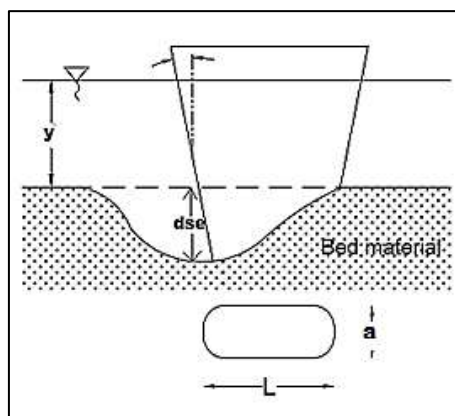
19 Vista lateral de la erosión local en pilar con estrechamiento hacia abajo.
